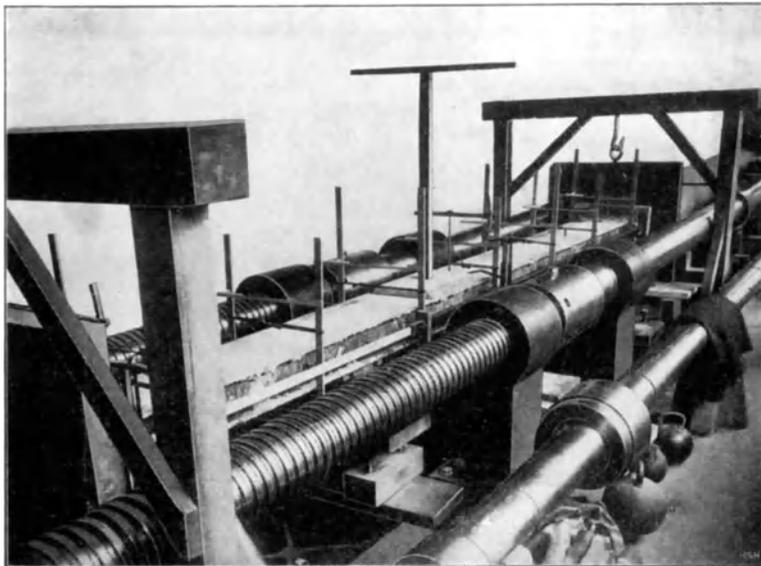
Knickversuch mit einer Eisen-Beton-Säule. Feinmessungen.
